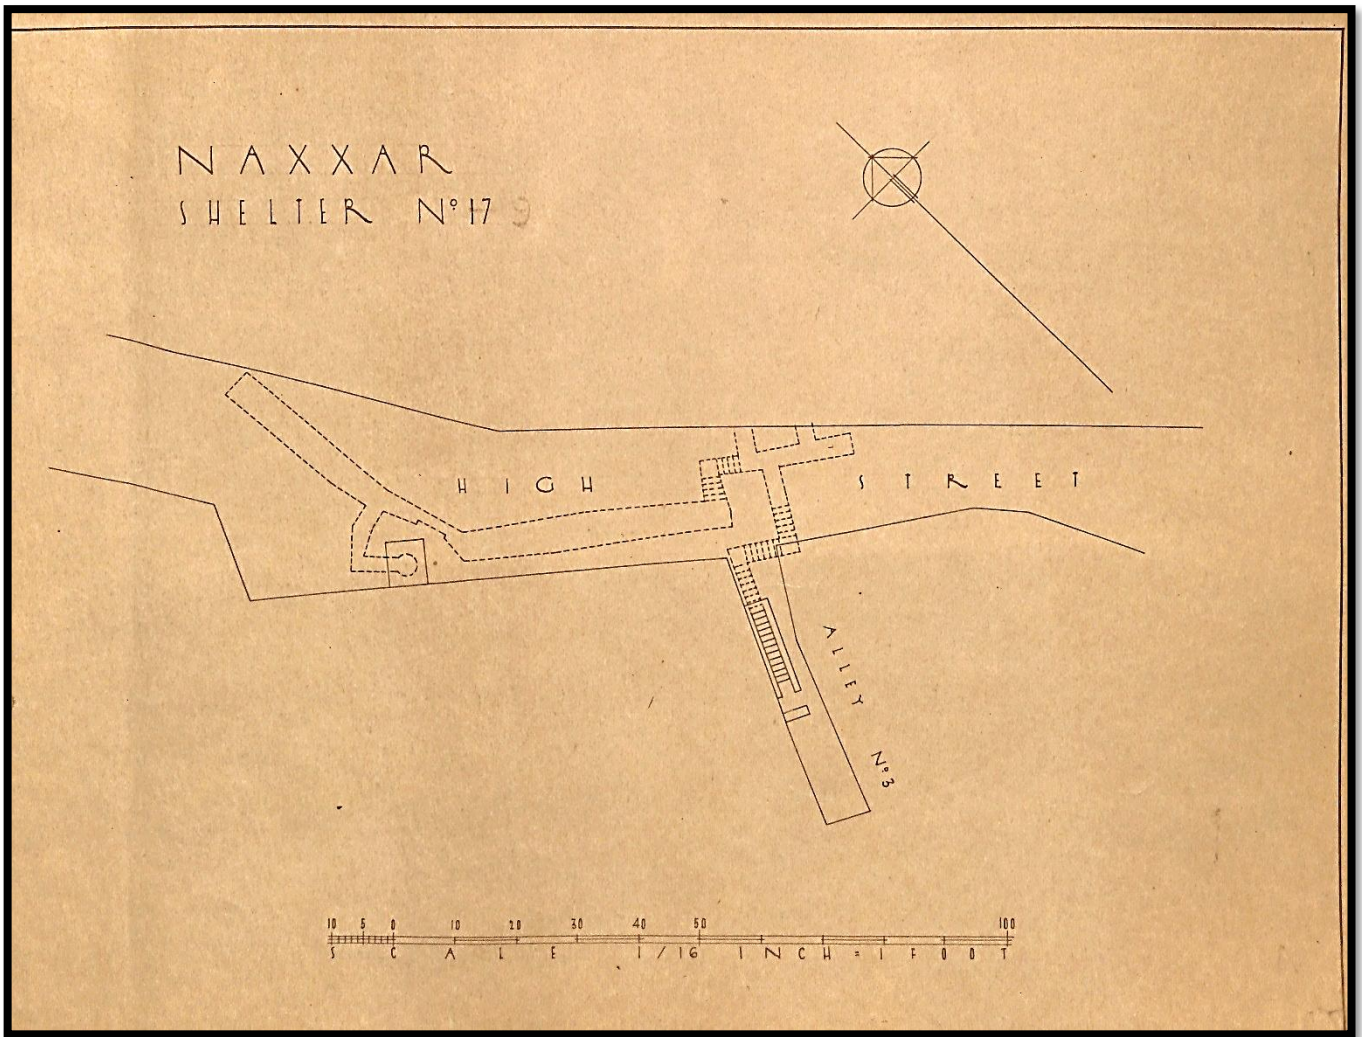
Planta do Abrigo nº17 (9) "High Street – Alley nº3"
